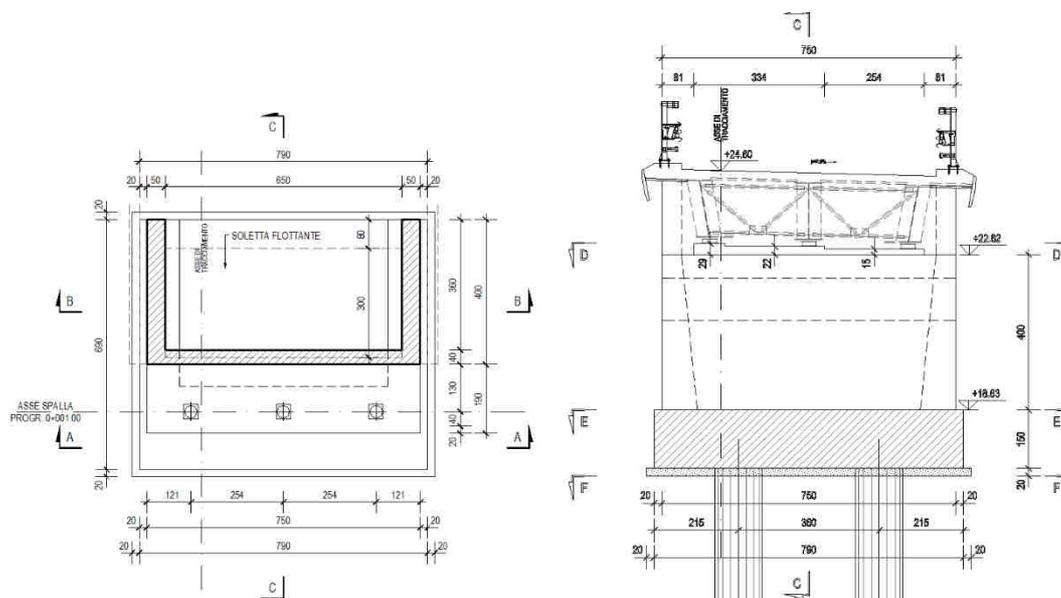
Spalla 1 – Pianta e prospetto – Cavalcavia Svincolo SS.125 – rampa 2
